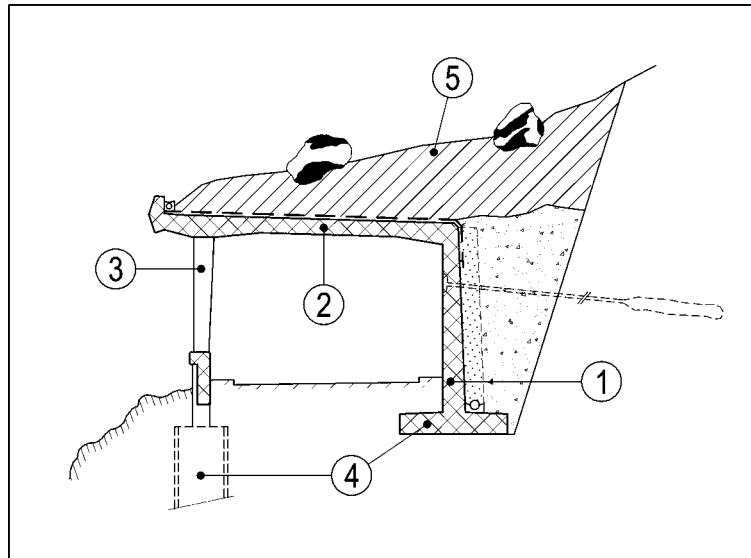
2 Schéma de principe des galeries usuelles LEGENDE : ① Mur amont ép. 0.40 m à 0.70 m, év. ancré, avec drainage arrière - ② Dalle de toiture en béton armé, avec étanchéité, ép. 0.40 m à 1.0 m, avec év. sommier noyé sur les piliers - ③ Piliers aval, 50 x 50 à 80 x 80, distants de 5 m à 8 m, avec parapet en pied - ④ Fondations, en général superficielles à l'amont, sur puits ou sur pieux à l'aval - ⑤ Couche de couverture ép. 0.50 m à 1.50 m, en matériaux calibrés, avec drainage vers bord aval
